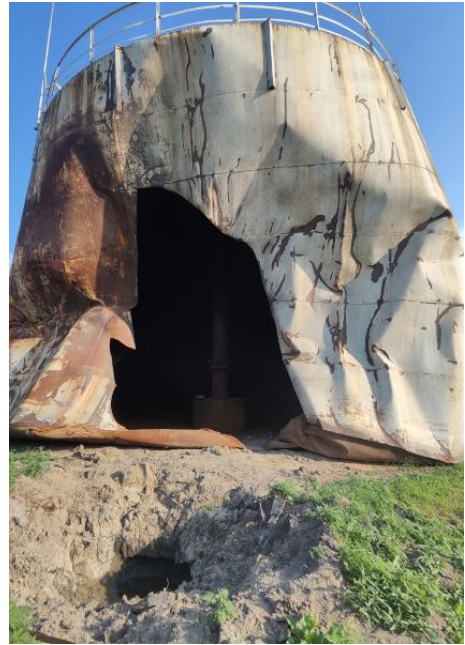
Руйнування стінки резервуара при наземному вибуху
